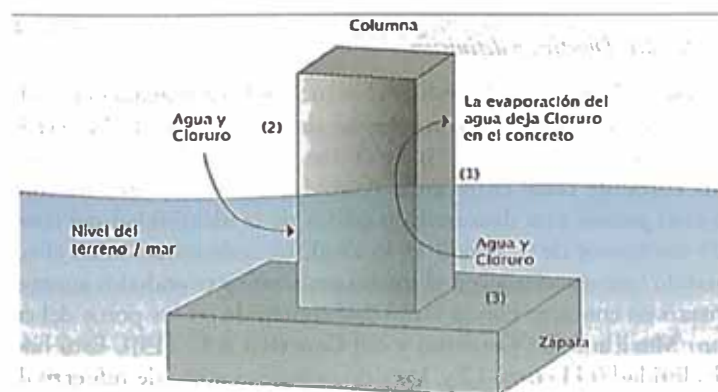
a.- Corrosión en la columna de concreto de pila
